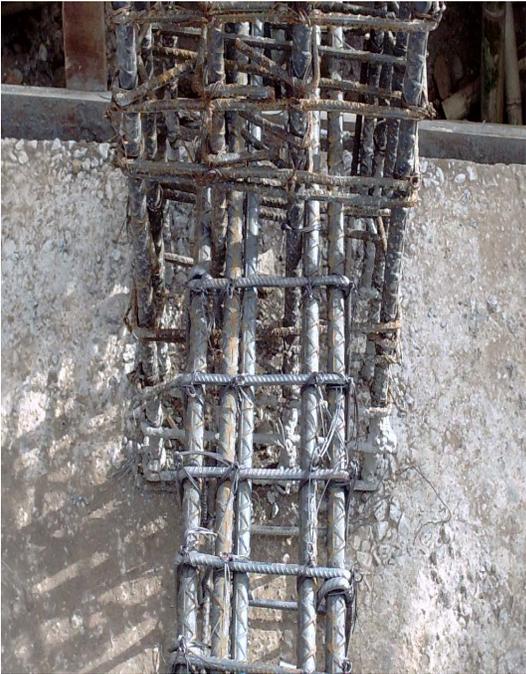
Vista general de refuerzo para vigas de cimentación bloque 2
